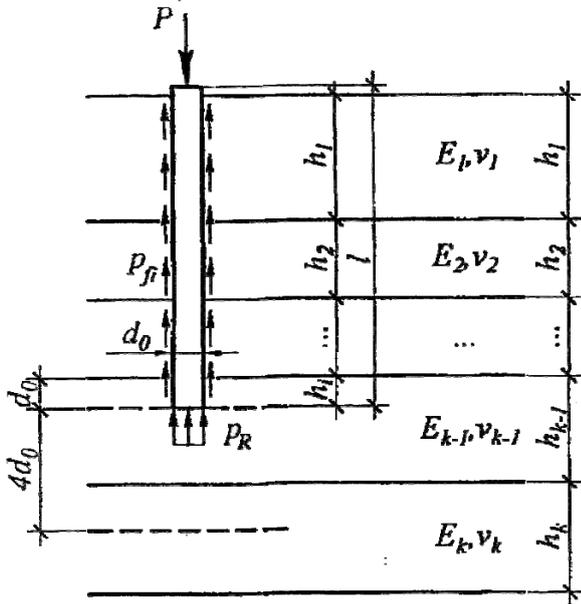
Расчетная схема для определения осадки вертикально нагруженной сваи в грунтовом основании, сложенном напластованием грунтов, при вертикальной нагрузке на сваю
